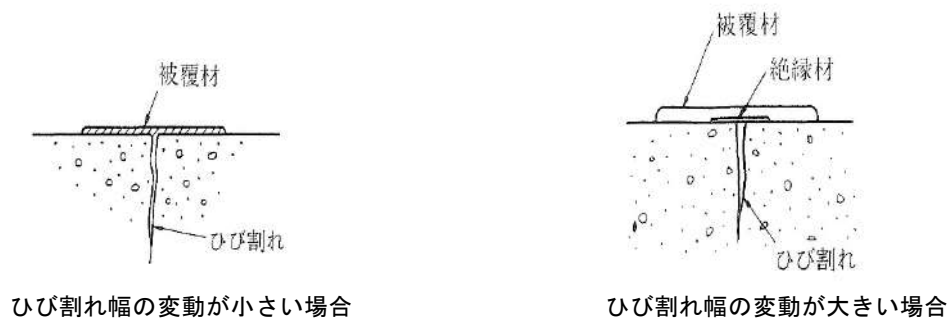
ひび割れ被覆工法の例
